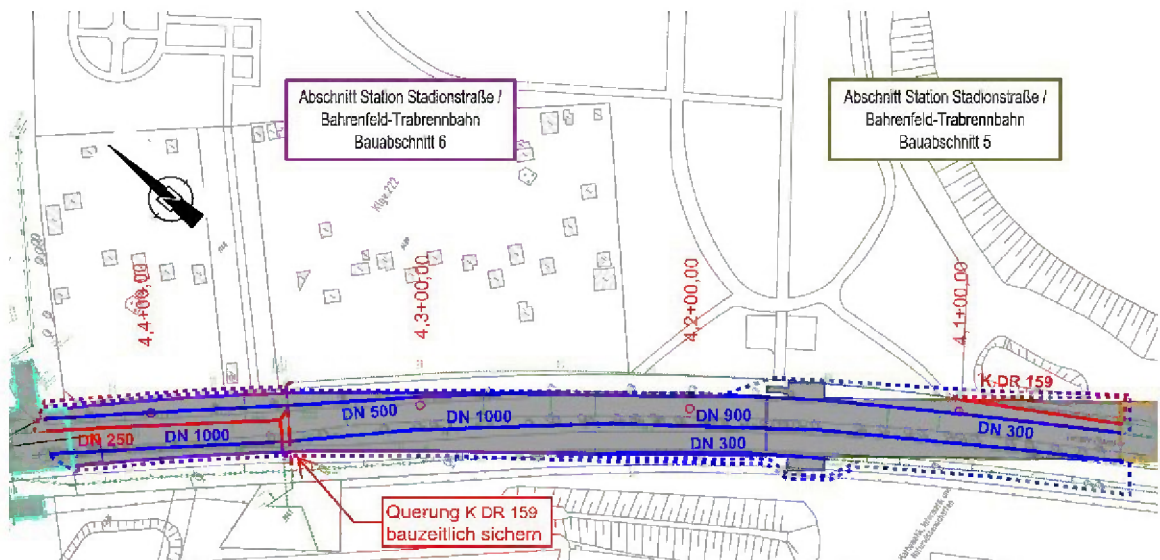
Sielplan Baubereich Abschnitt Bahrenfeld Trabrennbahn/Stadionstraße, Bauabschnitt 5 und 6 (Stand 04.2019)
